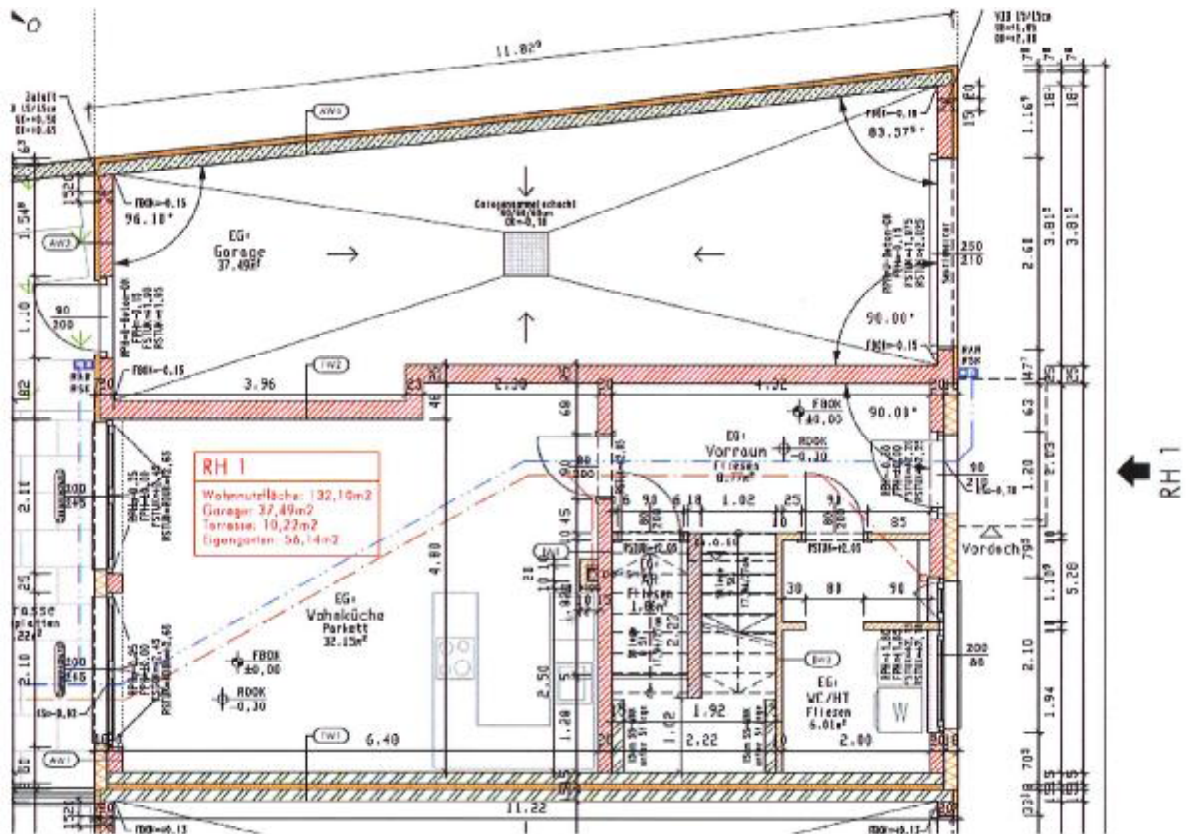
Grundriss Erdgeschoß Reihenhause 1 | 21.10.2021
